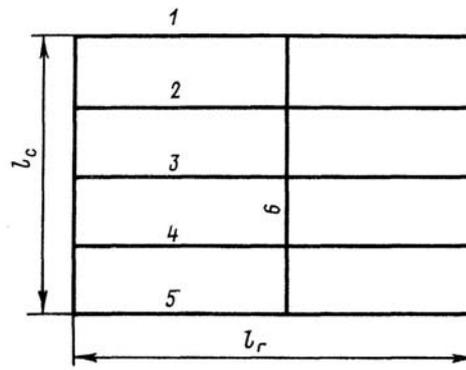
Схема перекриття з трьома горизонтальними рамами:
